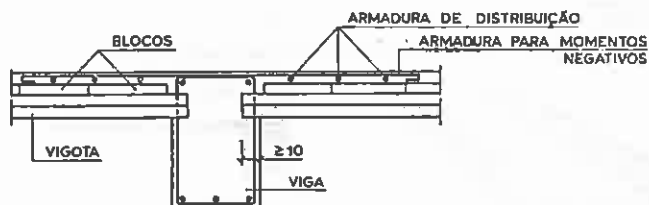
Vigotas pré-esforçadas: pormenor de apoio
